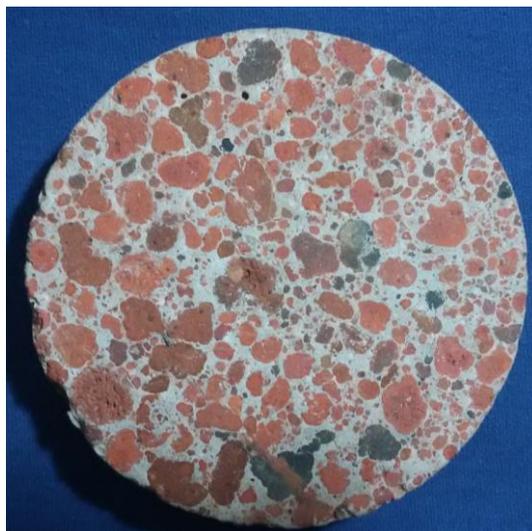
Sección transversal del cilindro de hormigón ligero de arena+grava de arcilla con adiciones de lodo residual Fuente: Autor
